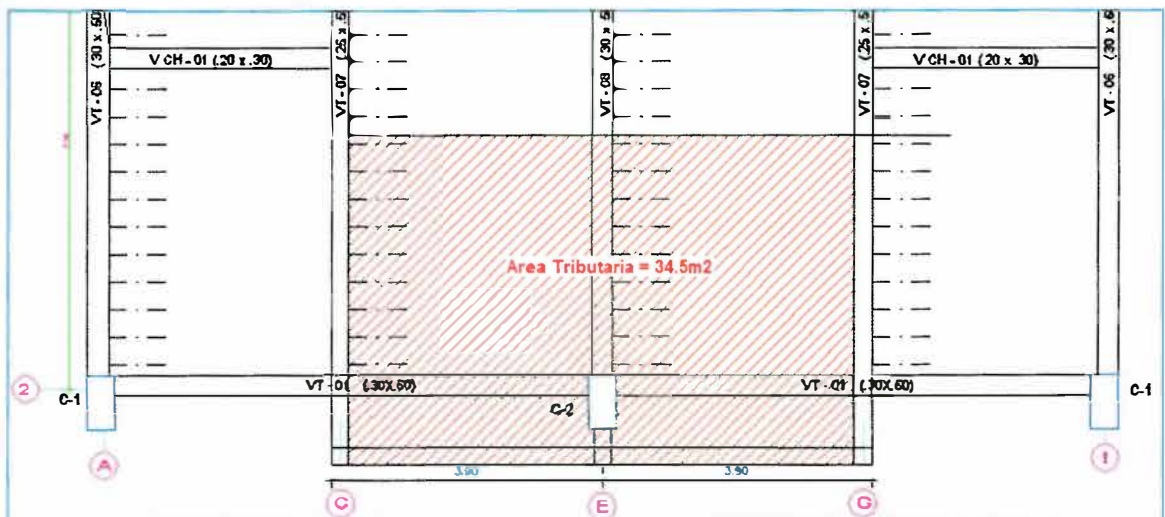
a Área tributaria de Columna de Fachada Central.
